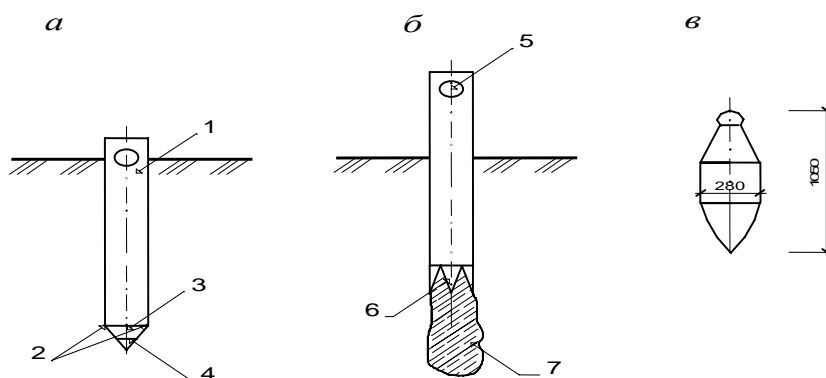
Оборудование для изготовления грунтовых свай:
